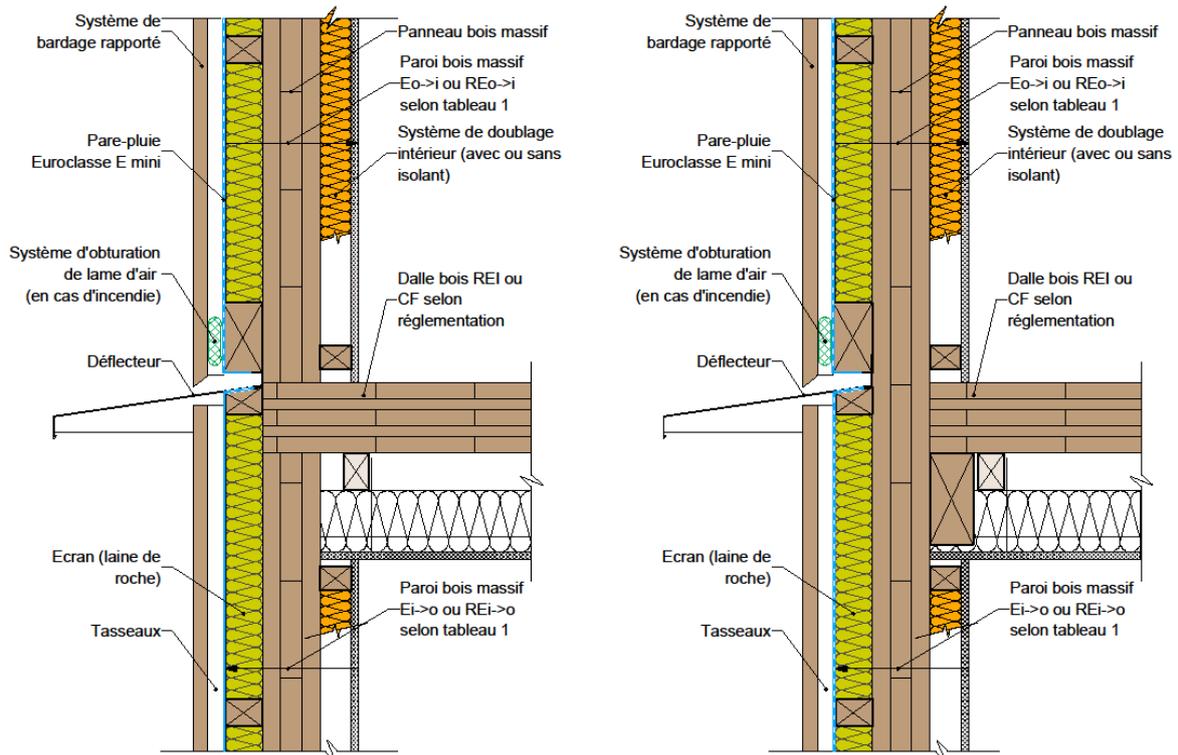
Façade/mur en panneaux bois massif & plancher en panneau bois massif.
